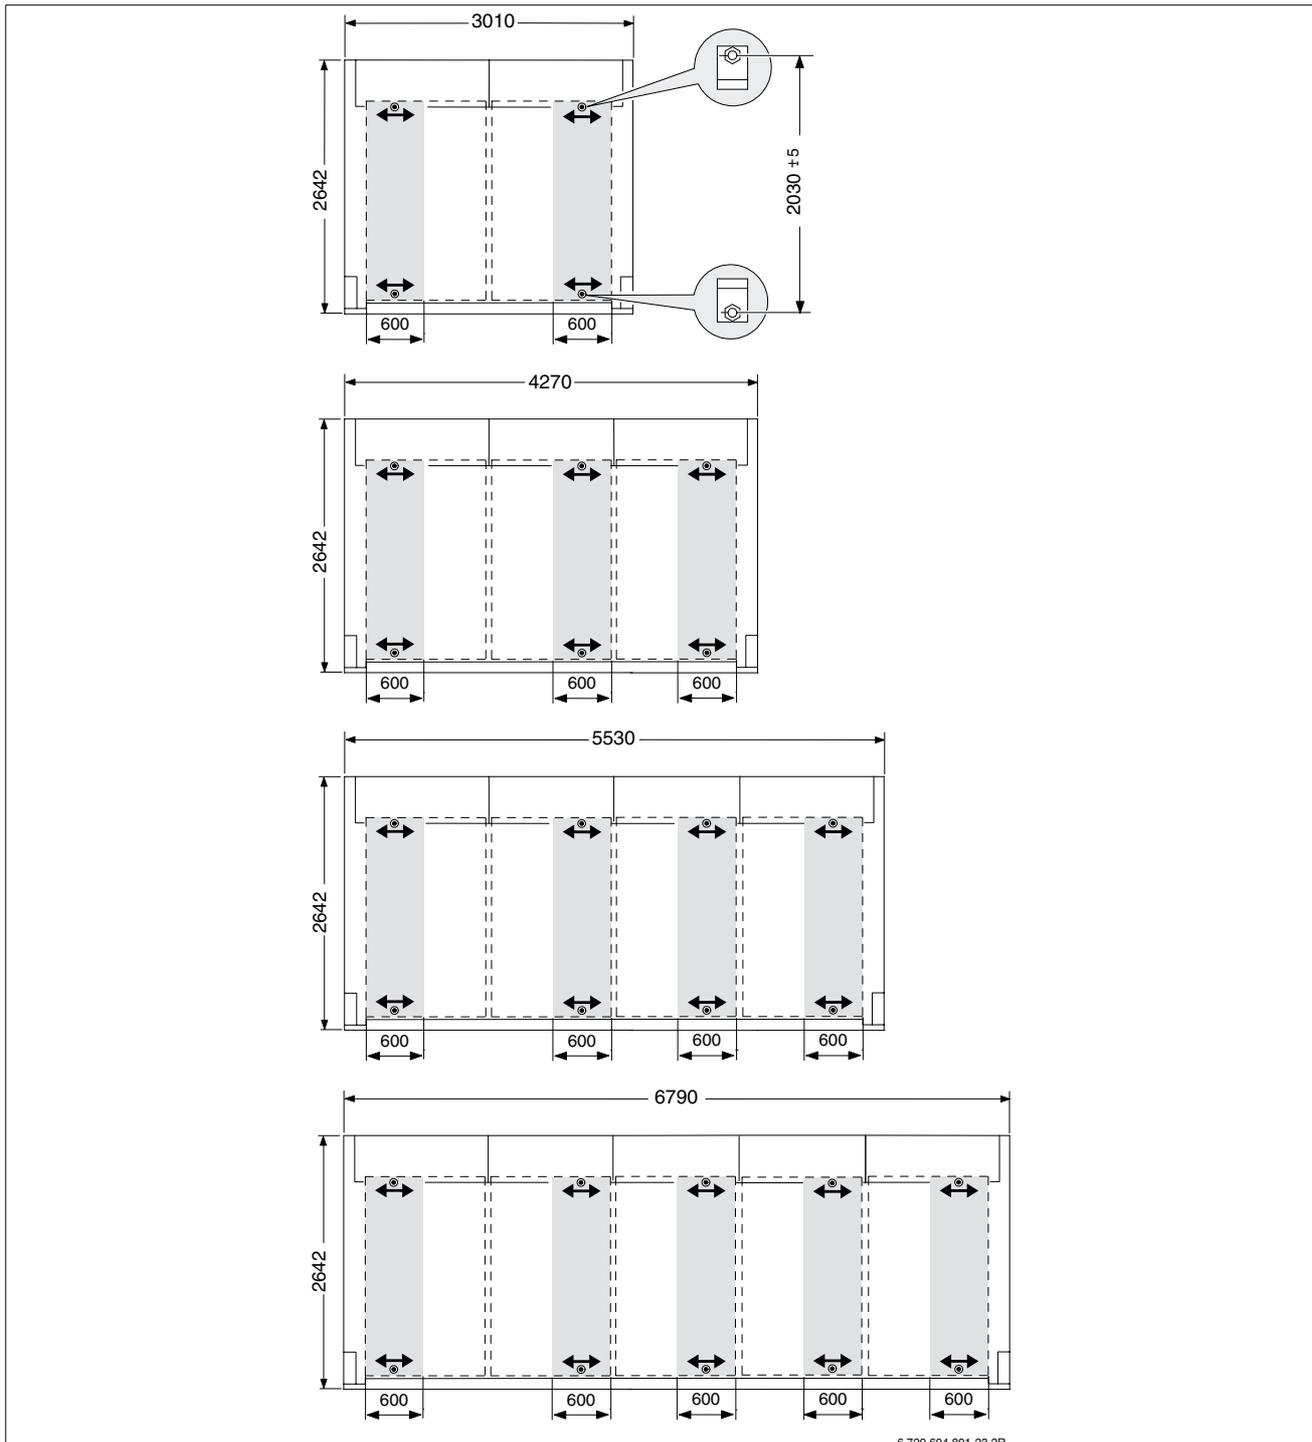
Außenmaße der Blecheinfassung und Toleranzbereiche für die Befestigung der Stockschrauben
